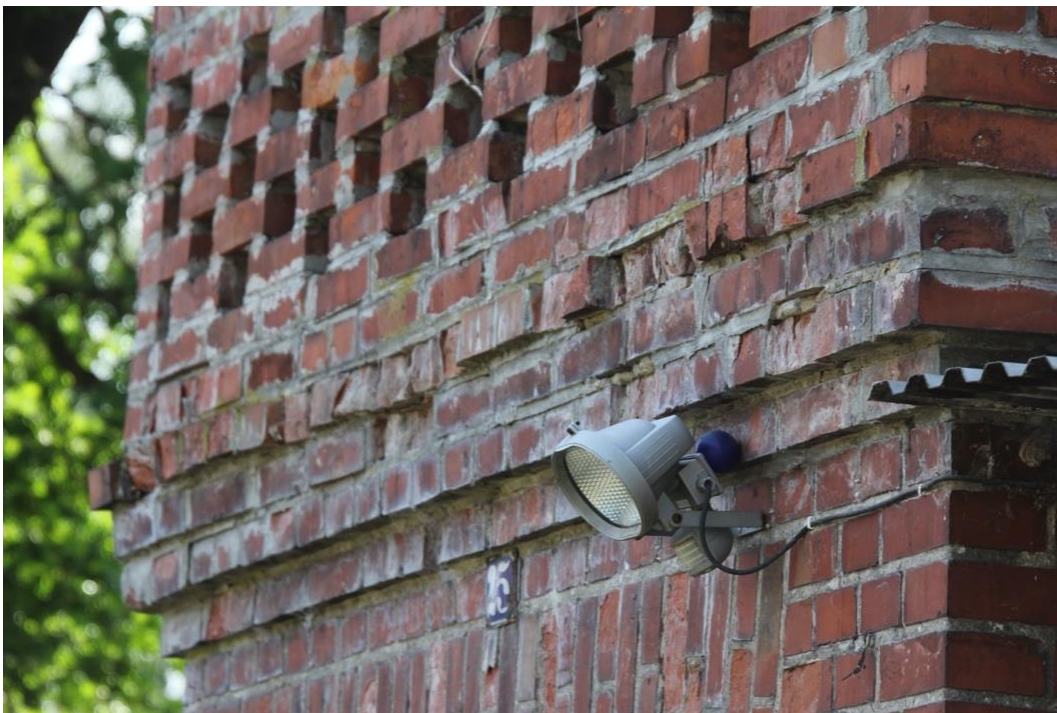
Elewacja frontowa, wschodnia . Szczyt ryzalitu.
